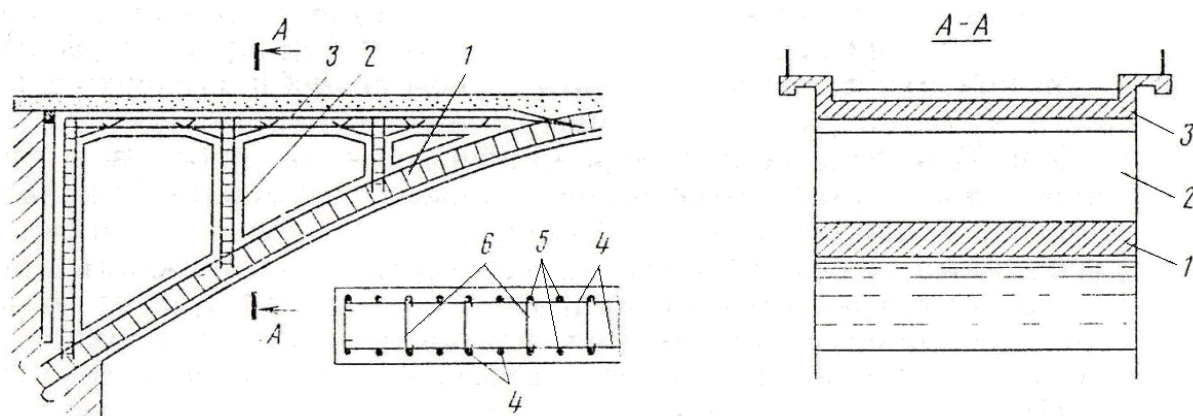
Железобетонные арочные мосты со сводами:
